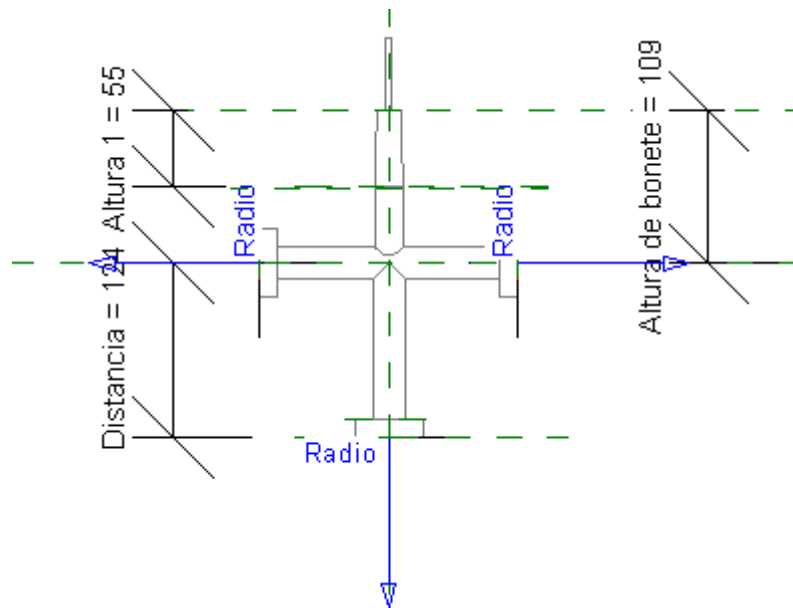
Alzado válvula de 3 vías biblioteca Revit
